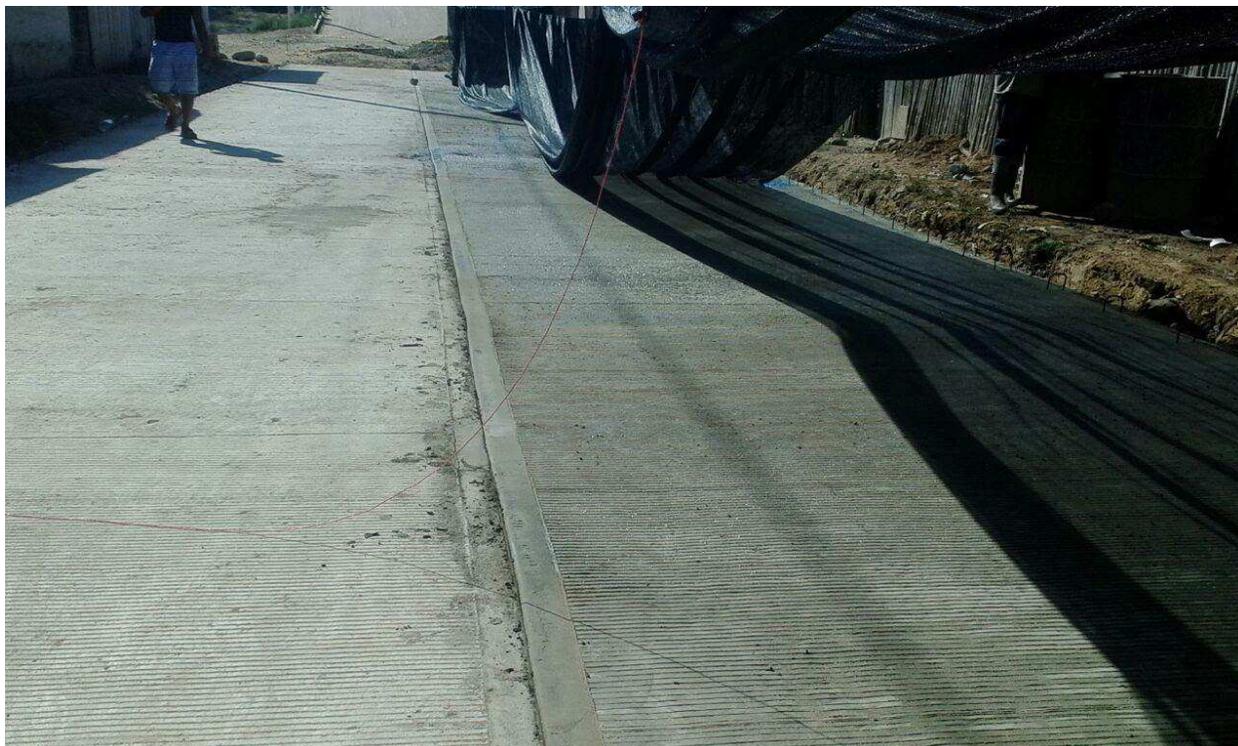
Detalle junta Longitudinal Calle 9 carreras 2-3
